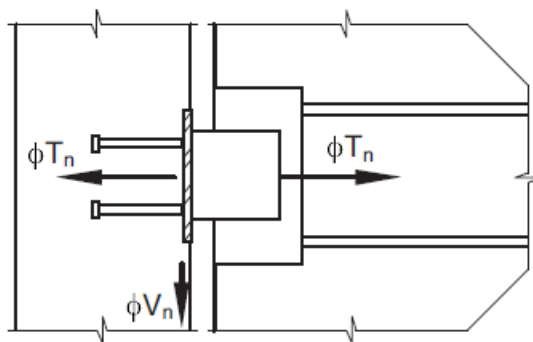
13 – Vista em planta das conexões existentes entre lajes duplo T e elementos de fechamento da estrutura (FONTE: Conexions Manual, 2008).
